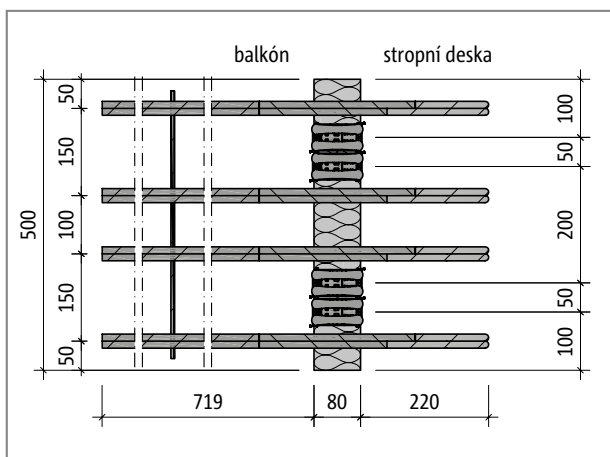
Schöck Isokorb® typ Q105-VV: Půdorys prvku
